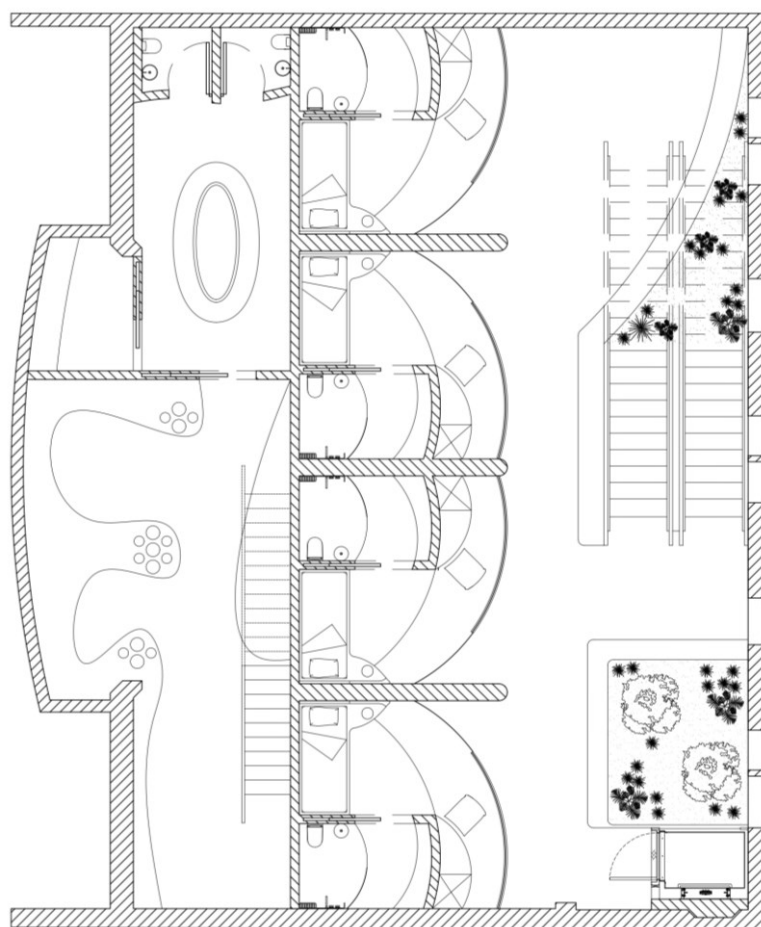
Planta de apresentação Piso -1 Fonte: Autor(es)
